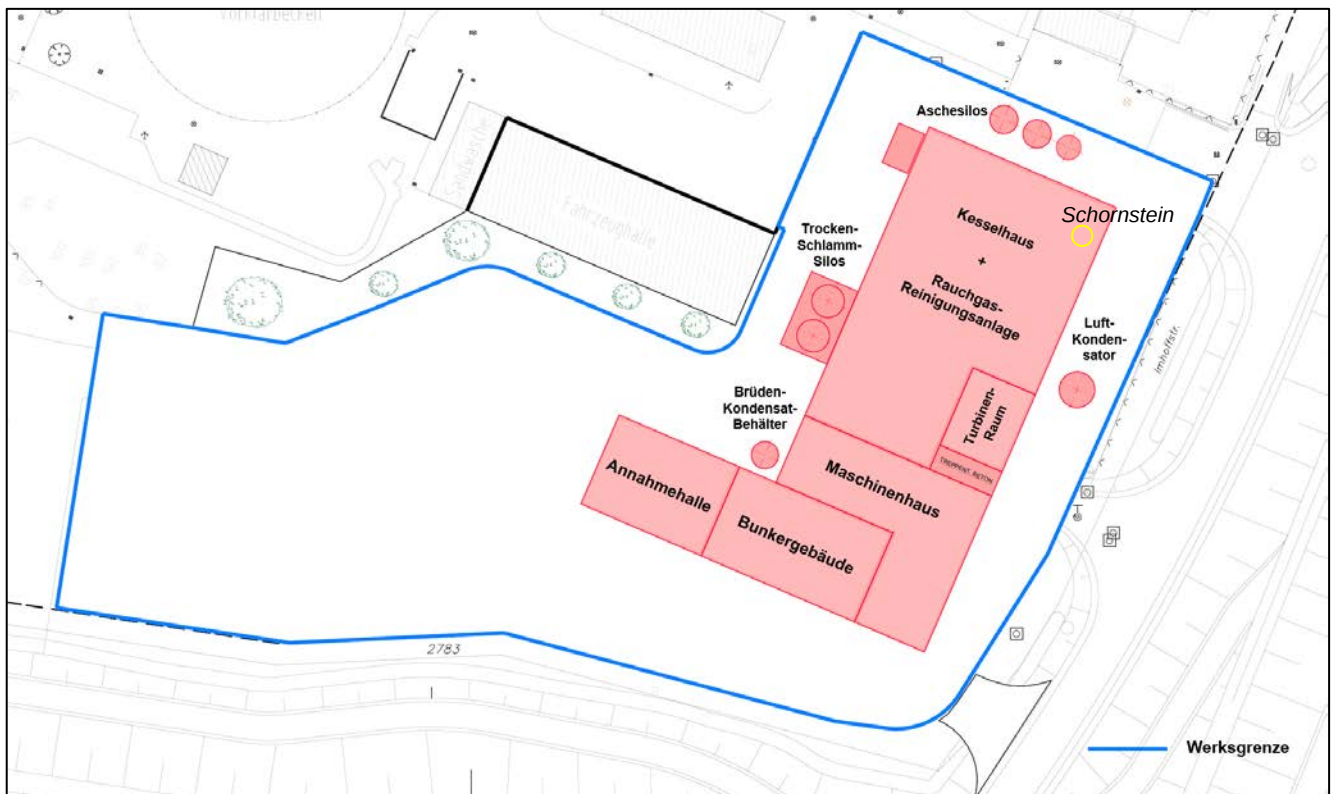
Lageplan und Werksgrenze der geplanten KVA
